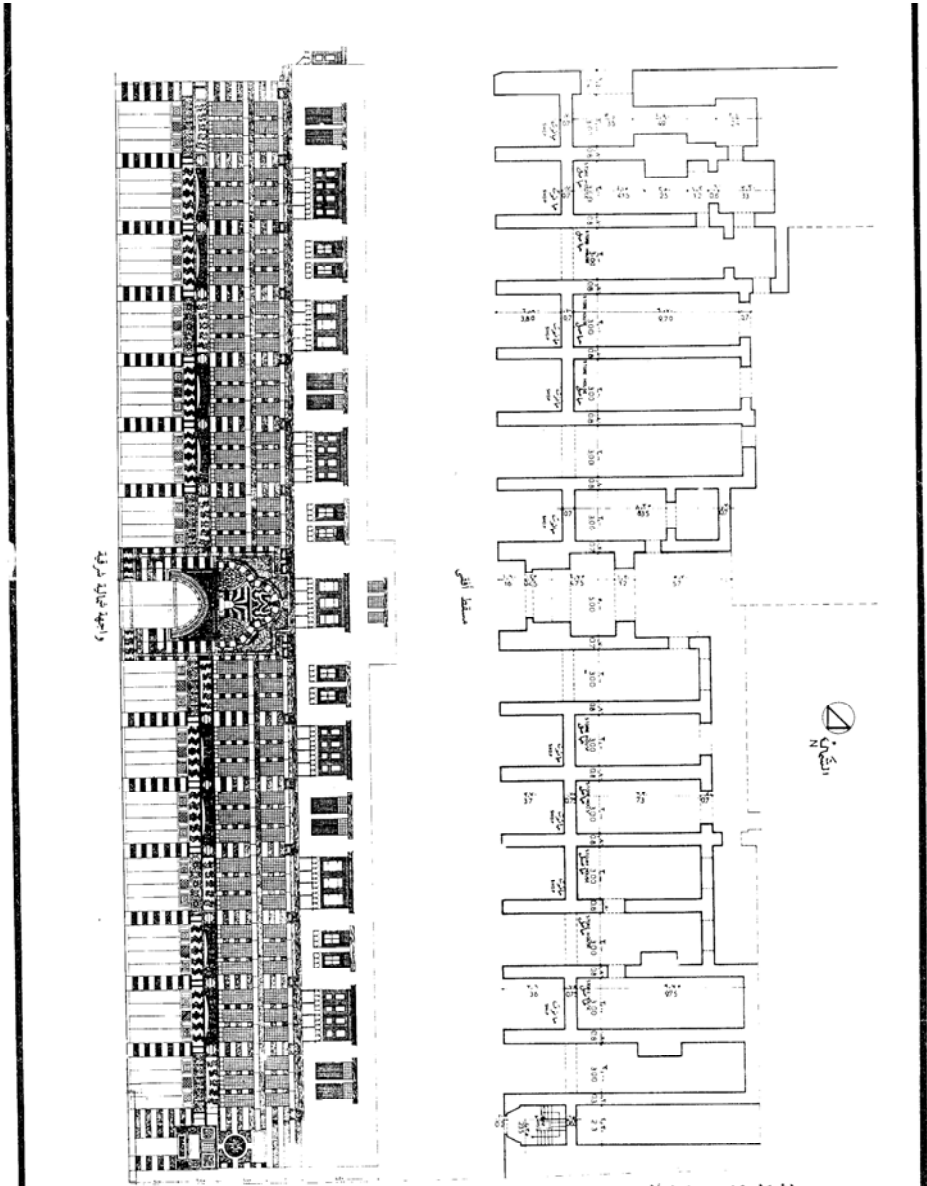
مسقط أفقي لوكالة قايتباي بباب النصر
